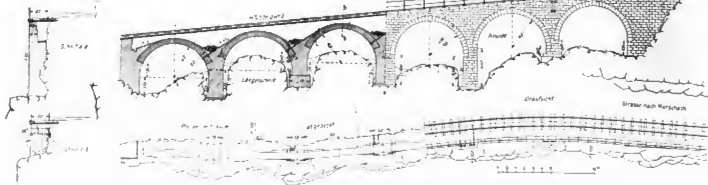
Lehnviadukt bei Km. 1,1 bis 1,2. — Grundriss, Ansicht, Längenschnitt und Querschnitte. — Massstab 1:400.
